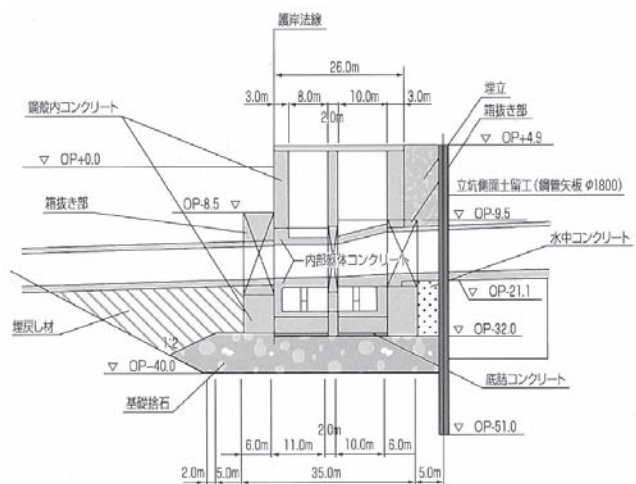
夢洲側立坑部 鋼殻ケーソン断面図
